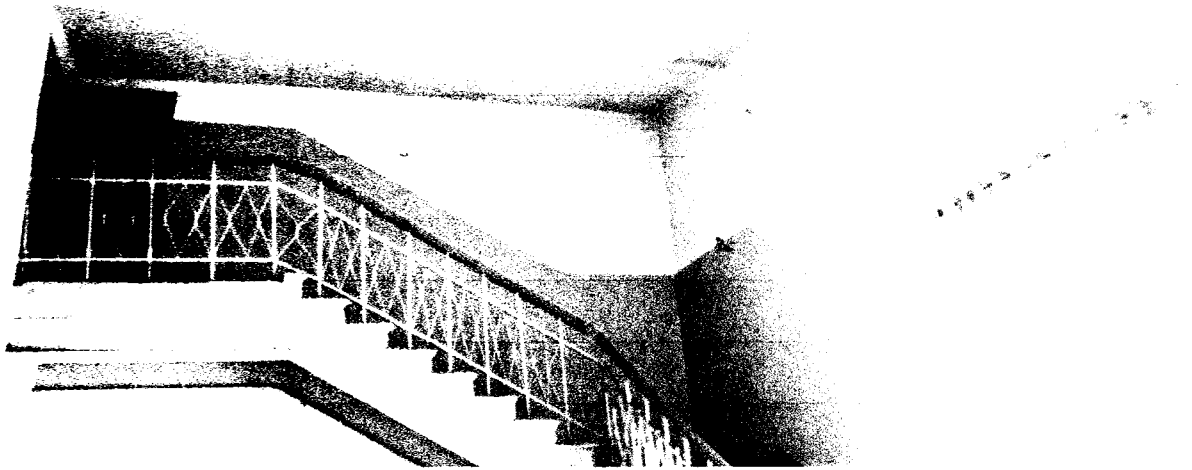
Фрагмент лестницы, ведущей на верхний этаж здания
